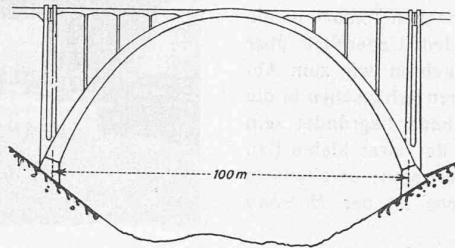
Eisenbahnbrücke Langwies, erbaut 1912/14.
